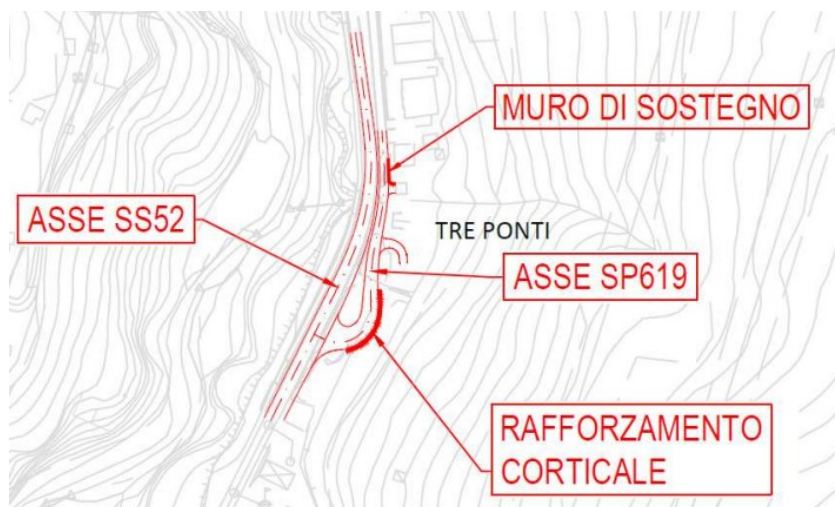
Planimetria delle opere di sostegno (Fonte: Lista di controllo)
